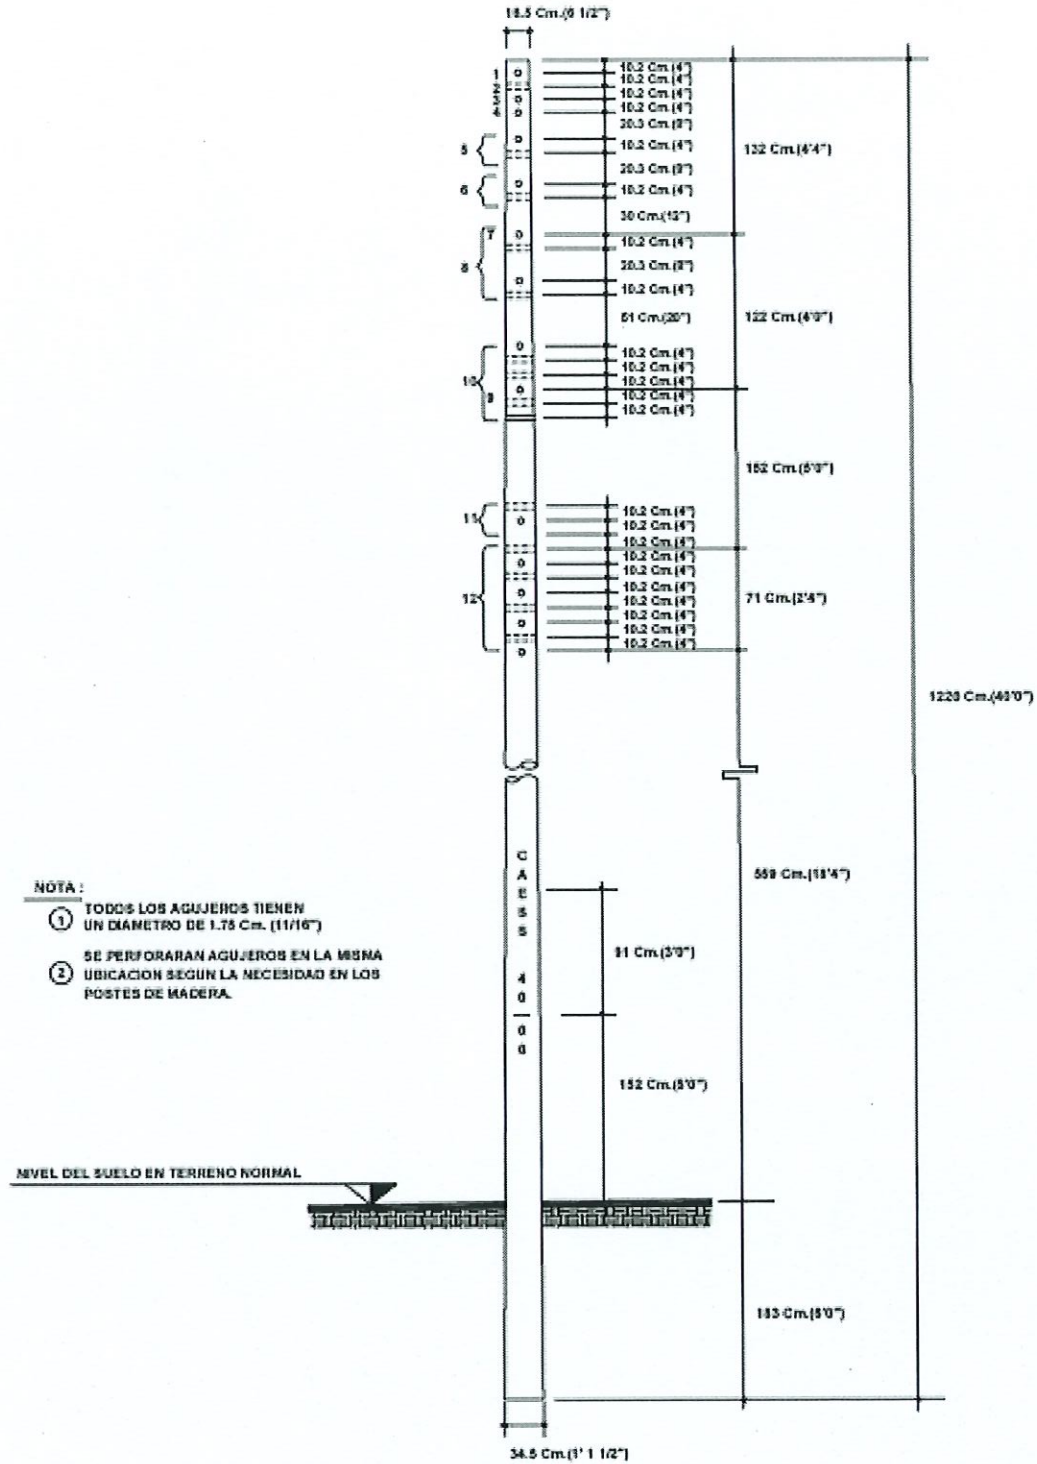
Postes de Concreto de 40 Pies (12.20 Metros)
